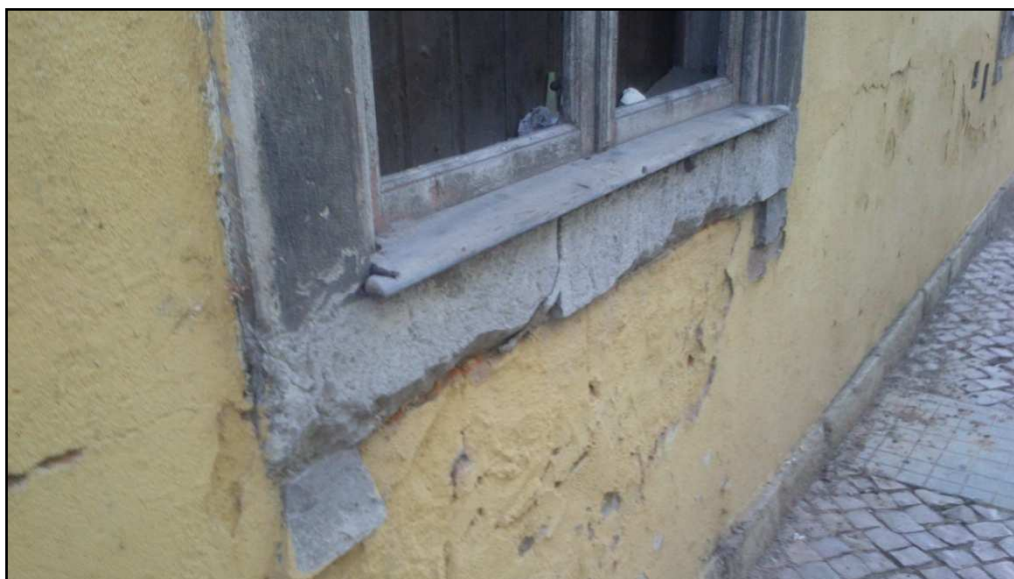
Pormenor da janela do piso térreo da fachada norte
